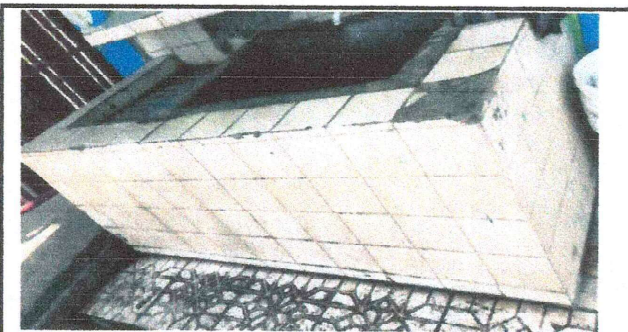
Sustrucción de azulejos en pila en modulo de pila
